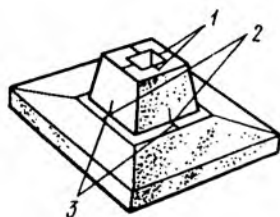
Совмещение рисок при монтаже фундамента под колонну:
